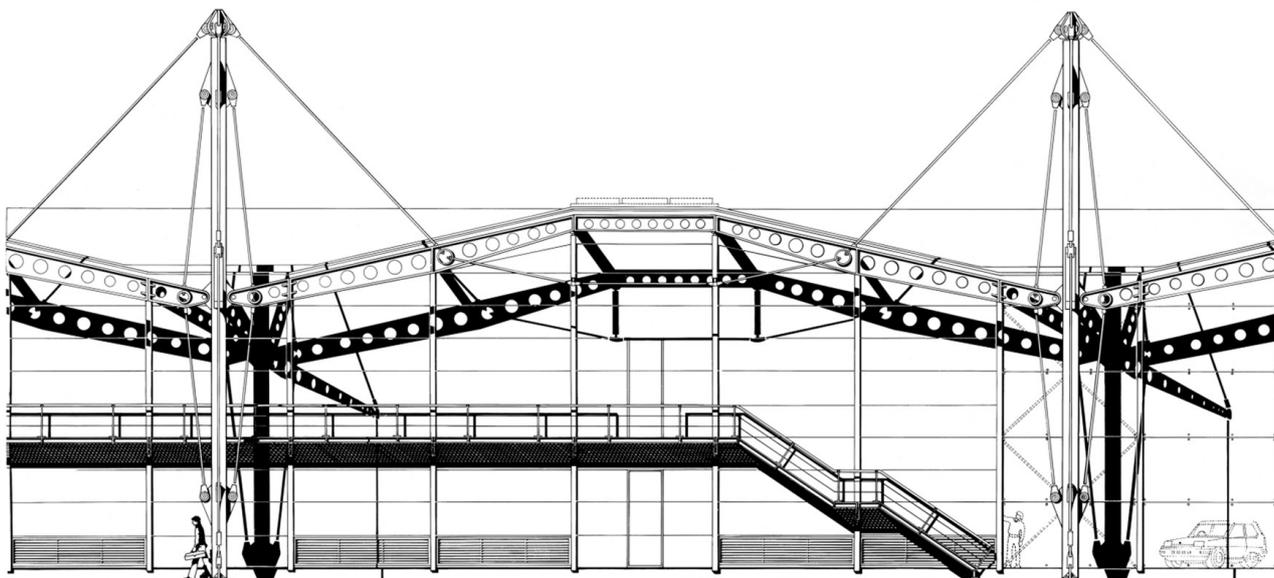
Centro de distribución Renault en Swindon: alzado. © Foster+Partners
